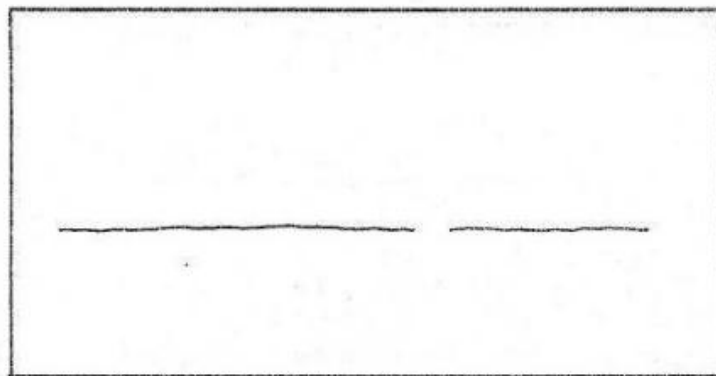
Fissuração típica da alvenaria causada por sobrecarga vertical
